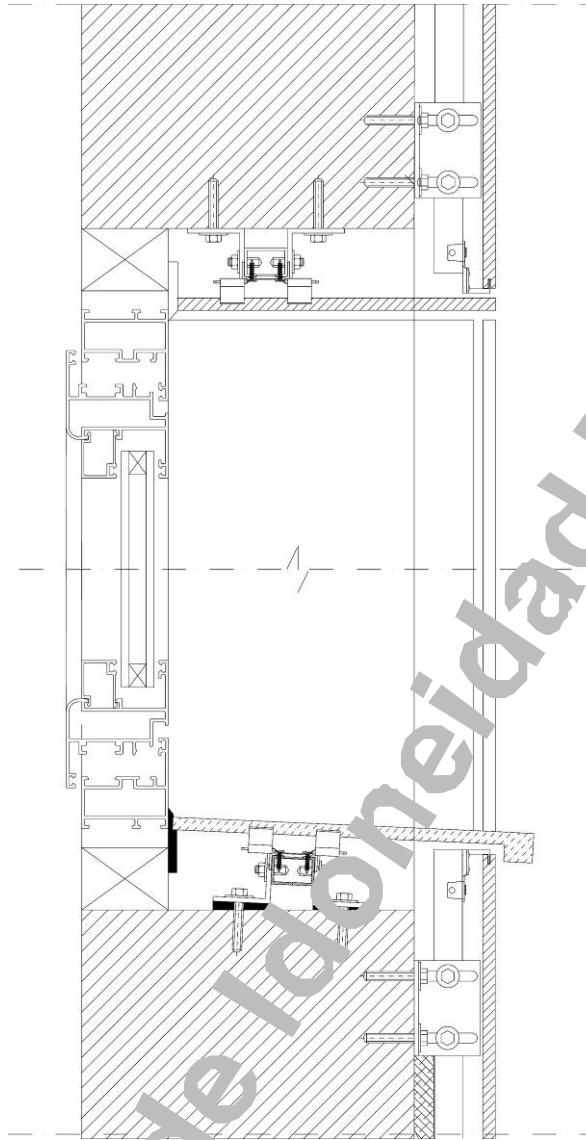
DETALLE DE HUECO. SECCIÓN HORIZONTAL
